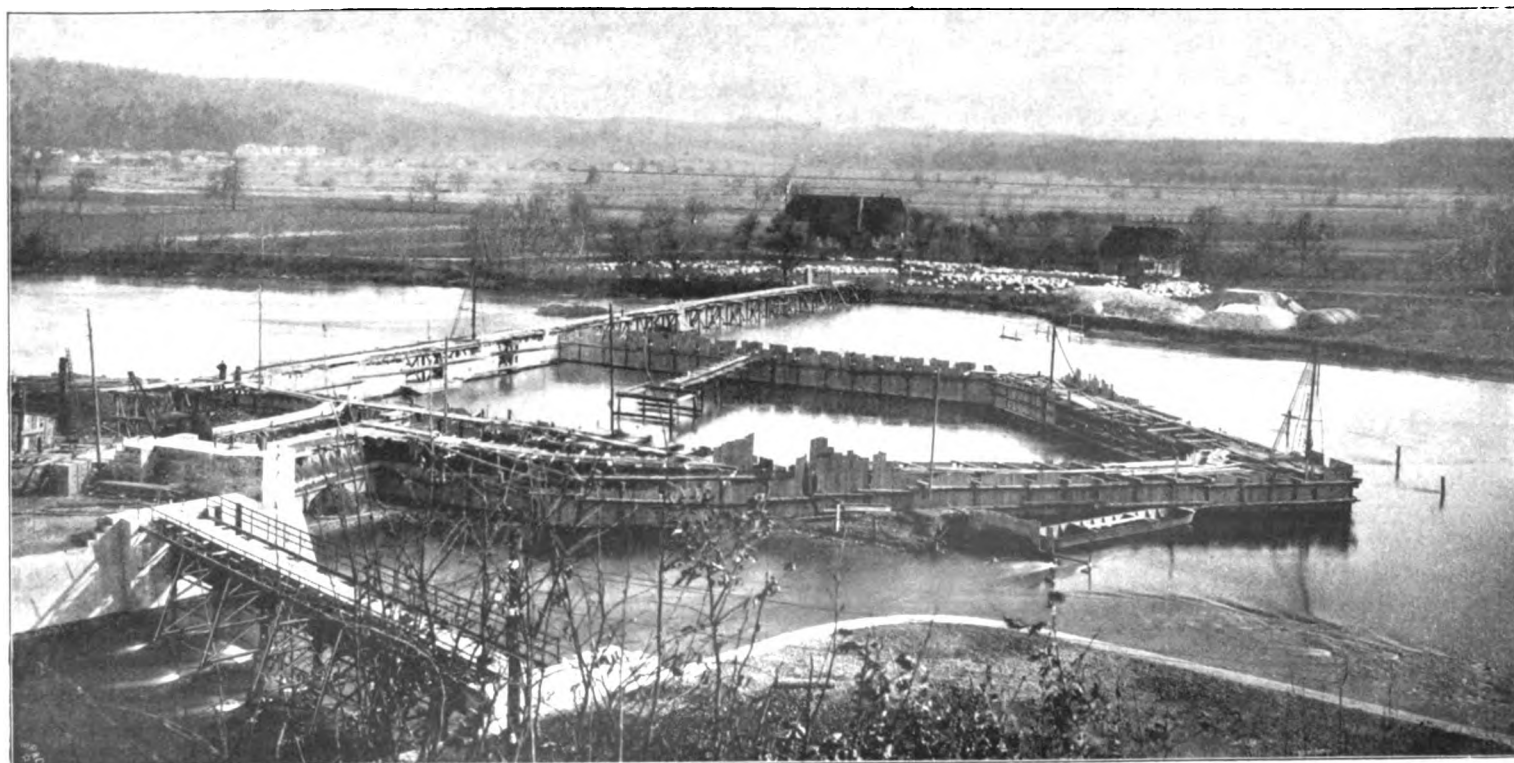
Bau des Wehres mit trocken gelegten Baugruben.
